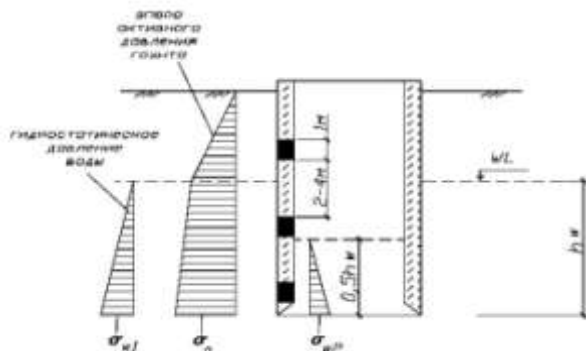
Схема к расчету стен опускного колодца на изгиб в горизонтальной плоскости
